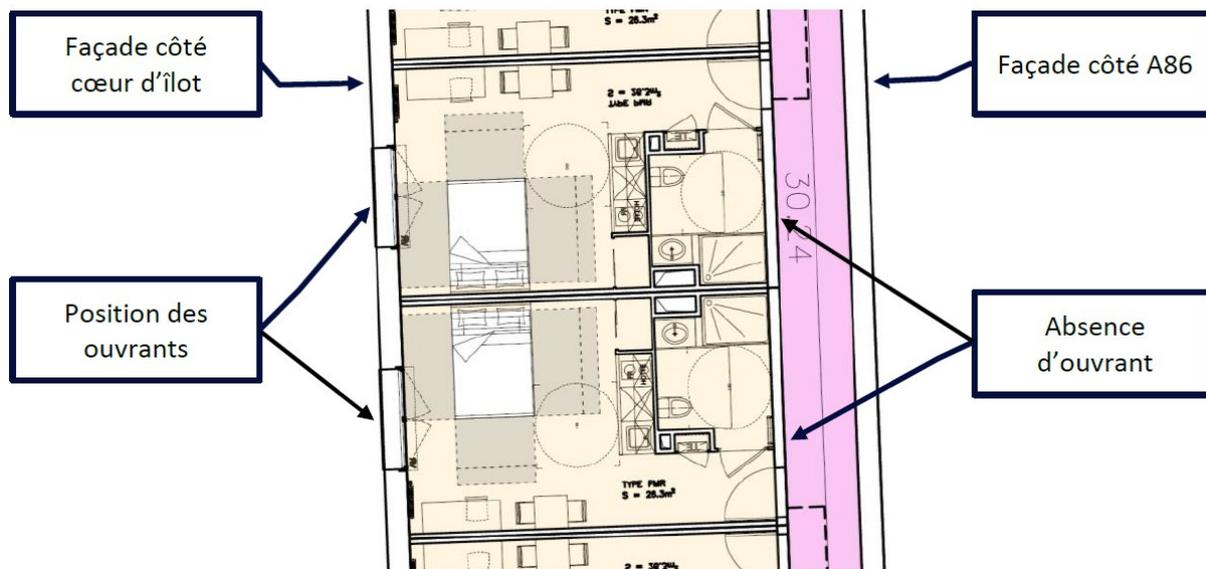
Plan des futurs logements en façade de l'A86 (R+3)
